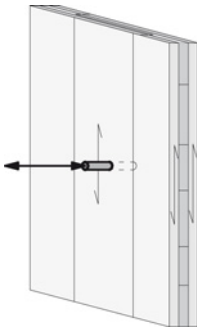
Mezzi di collegamento nella superficie (anche quella laterale stretta) sollecitati all'estrazione
